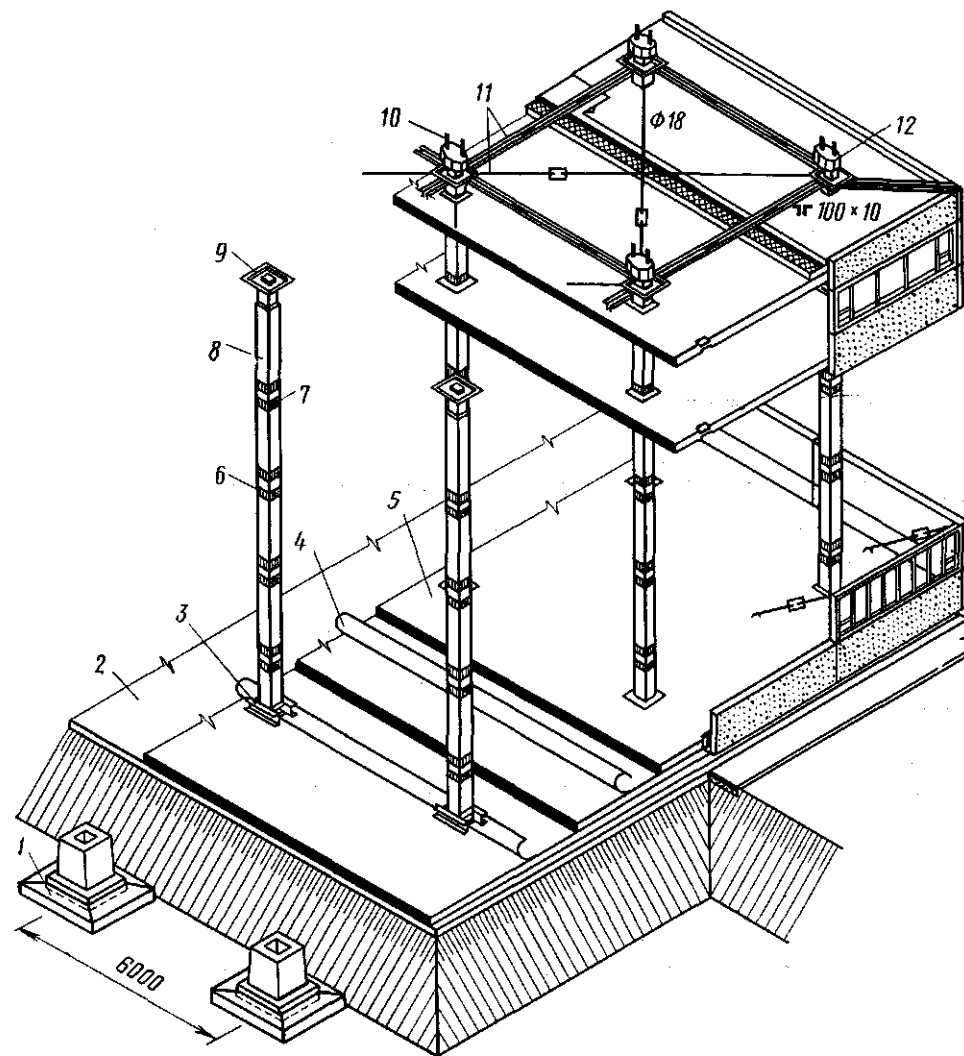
Многоэтажное здание, возводимое методом подъема этажей:
